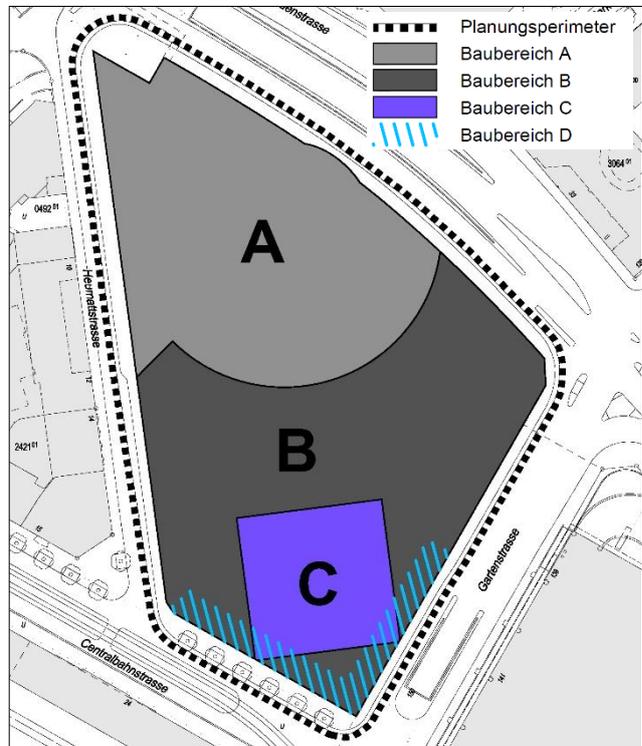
Bebauungsplan Nr. 214 (genordet);
